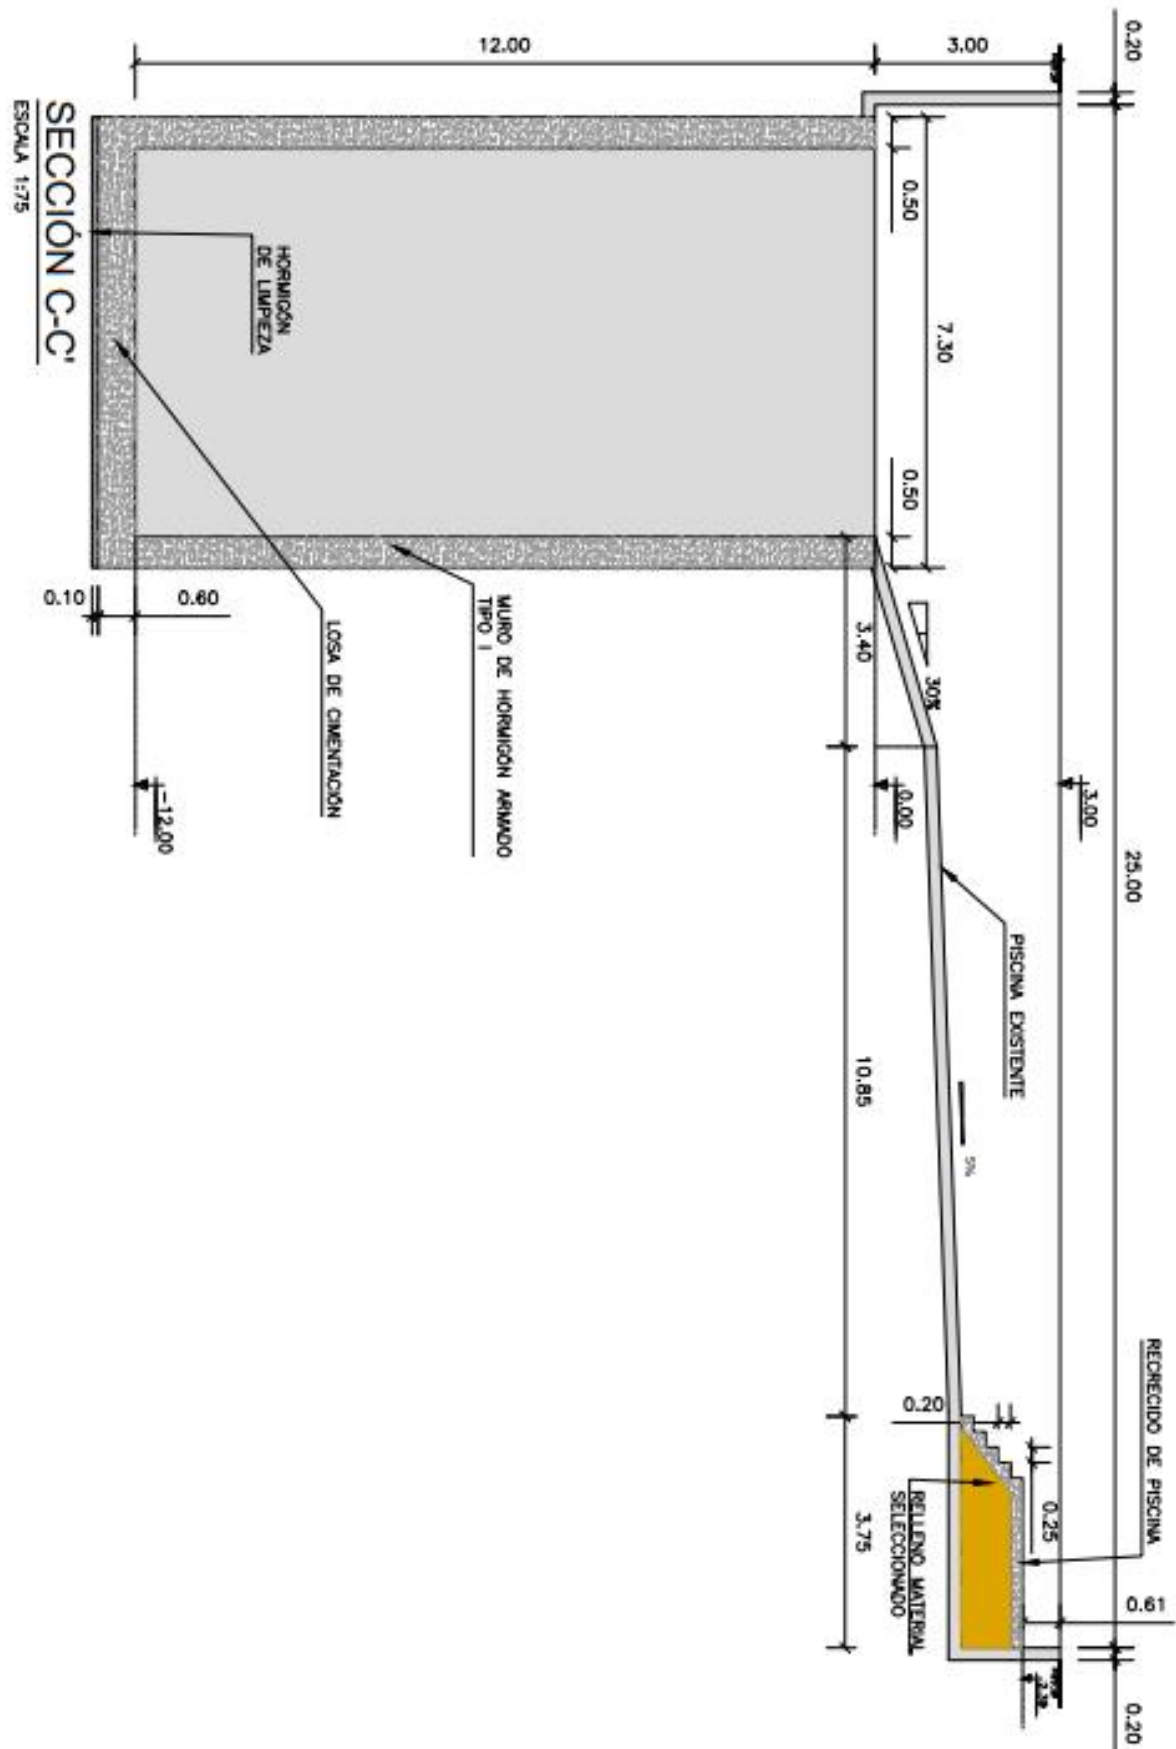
Plano de corte en perfil: vaso piscina avanzada
